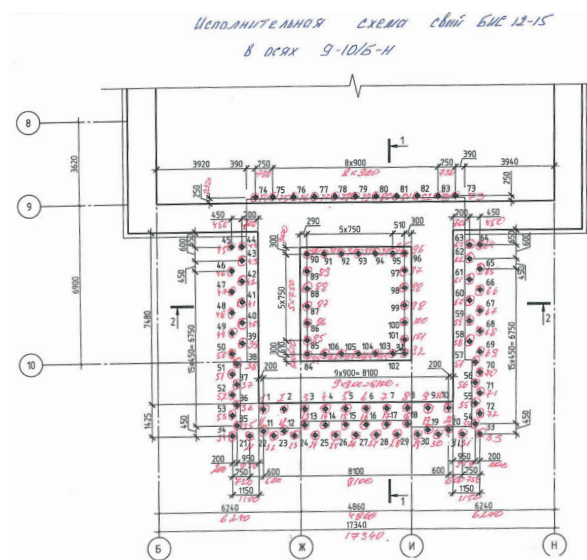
Усиление фундаментов путем устройства буроинъекционных свай (исполнительные схемы)
